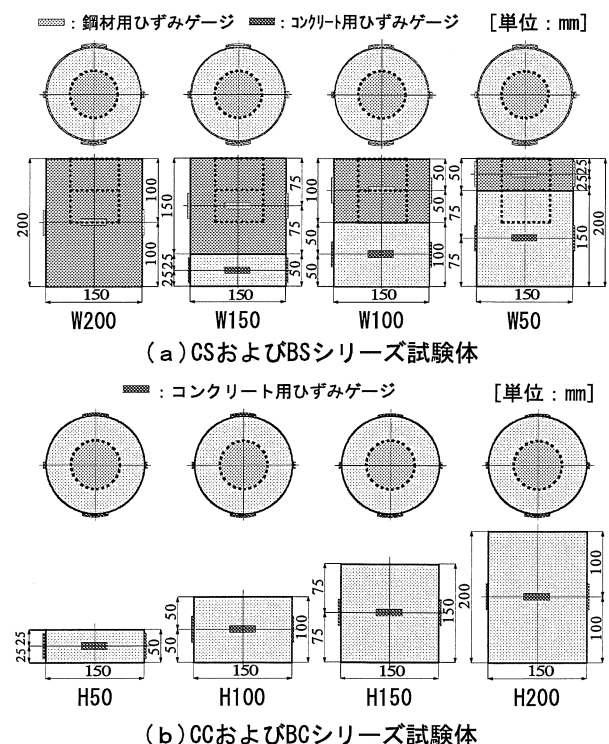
試験体の形状・寸法、ひずみゲージ貼付位置
